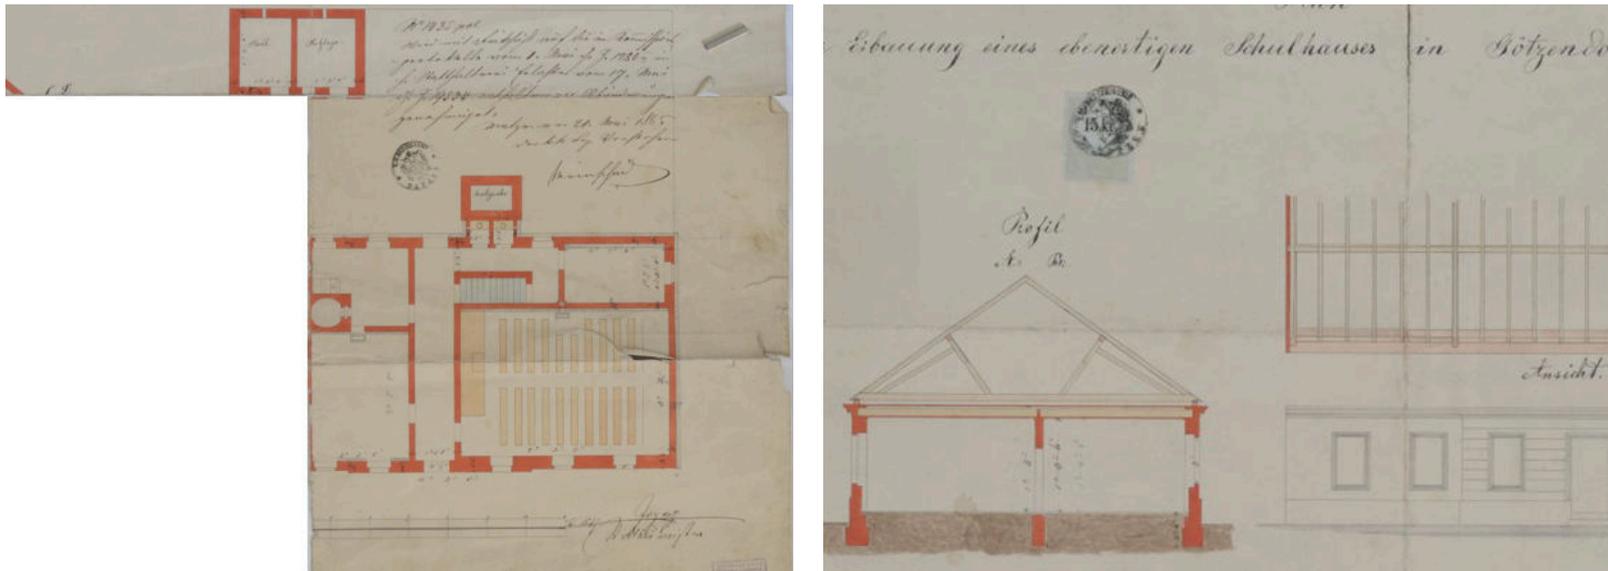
Ausschnitt Einreichplan zur Erbauung eines ebenerdigen Schulhauses, genehmigt 1865
